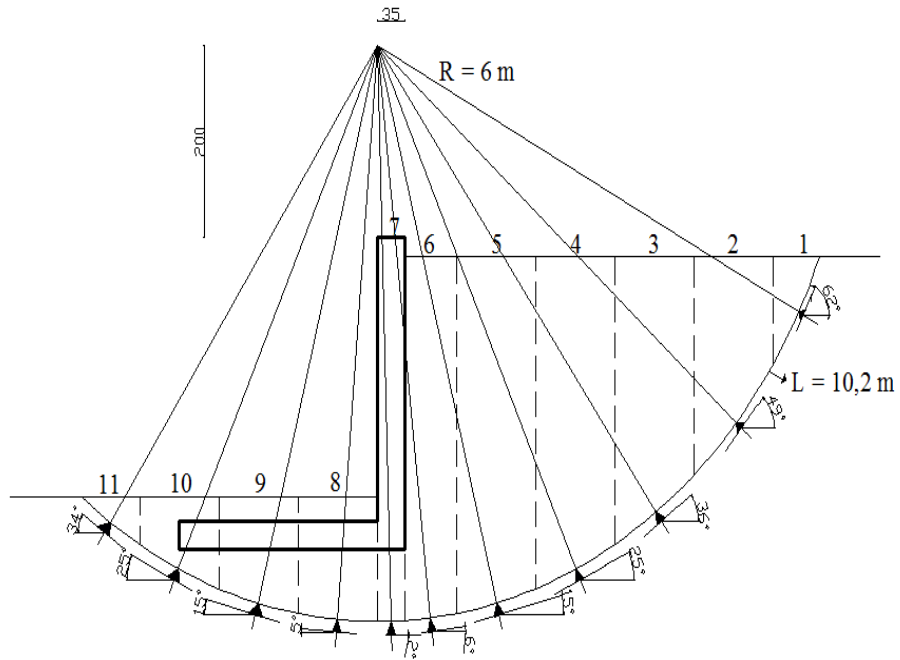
1 nolu istinatın yeniden boyutlandırma sonrası plan görünümü
